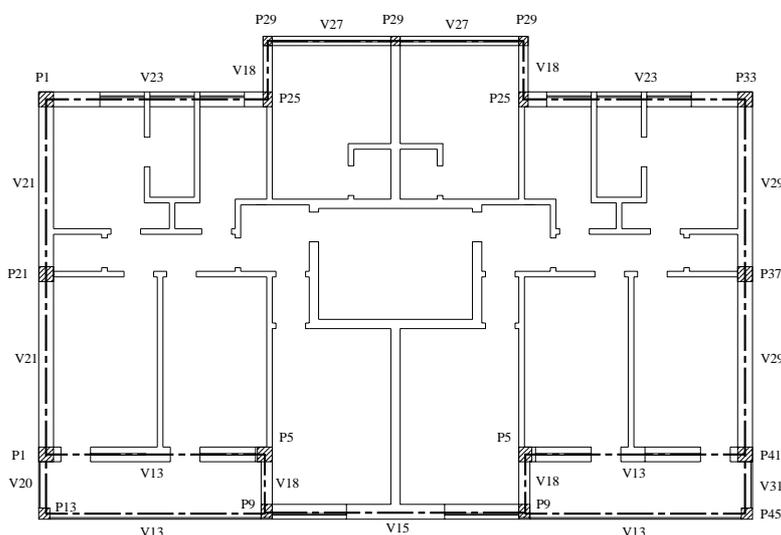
Planta de piso de um edifício de "placa", com 4 pisos elevados e com pilares e vigas em betão armado em toda a envolvente.
